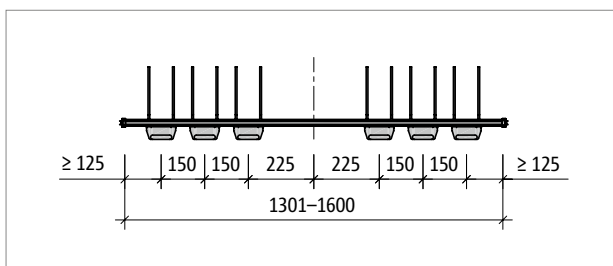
Schöck Tronsole® typ T-V4...-L1301 až L1600: Půdorys prvku
